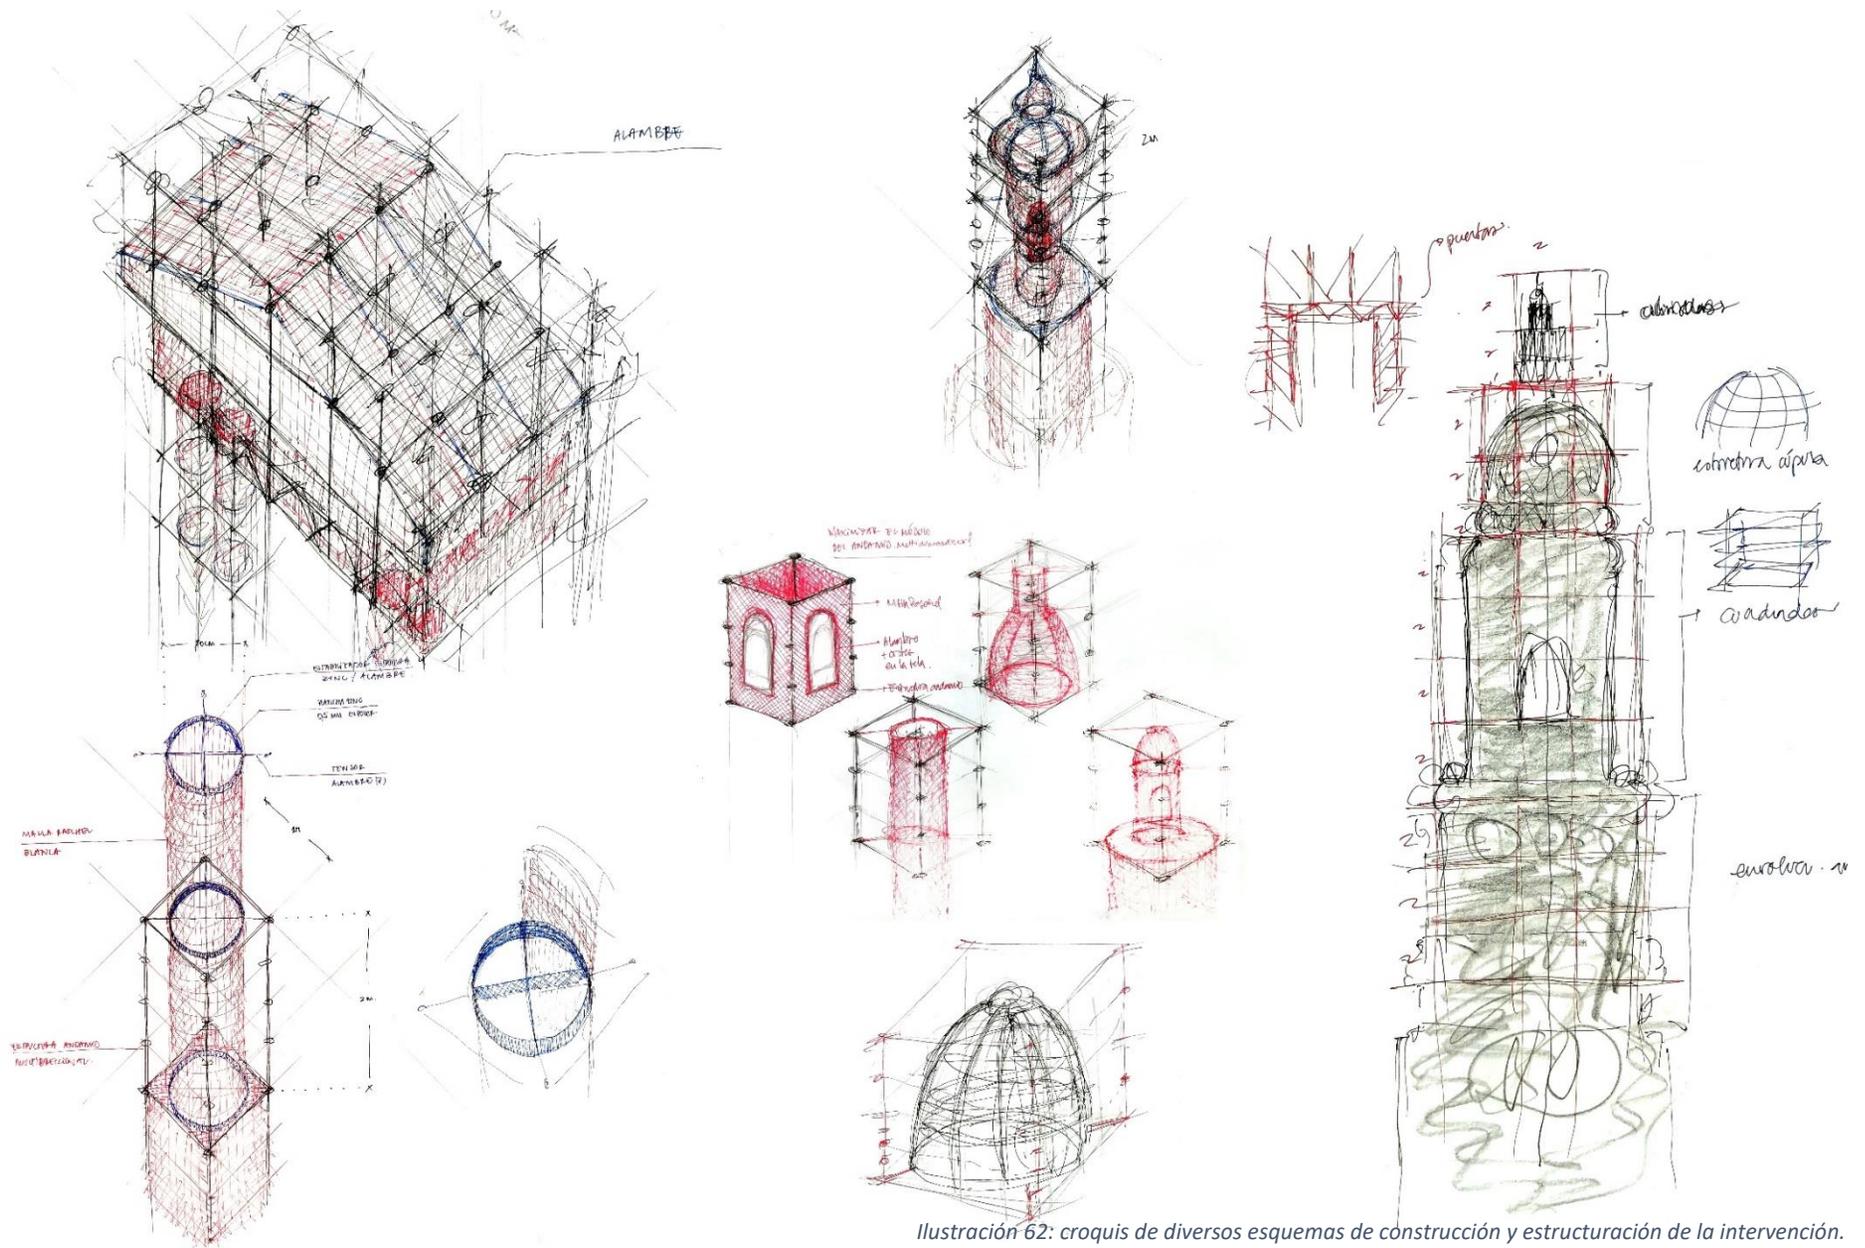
croquis de diversos esquemas de construcción y estructuración de la intervención.
